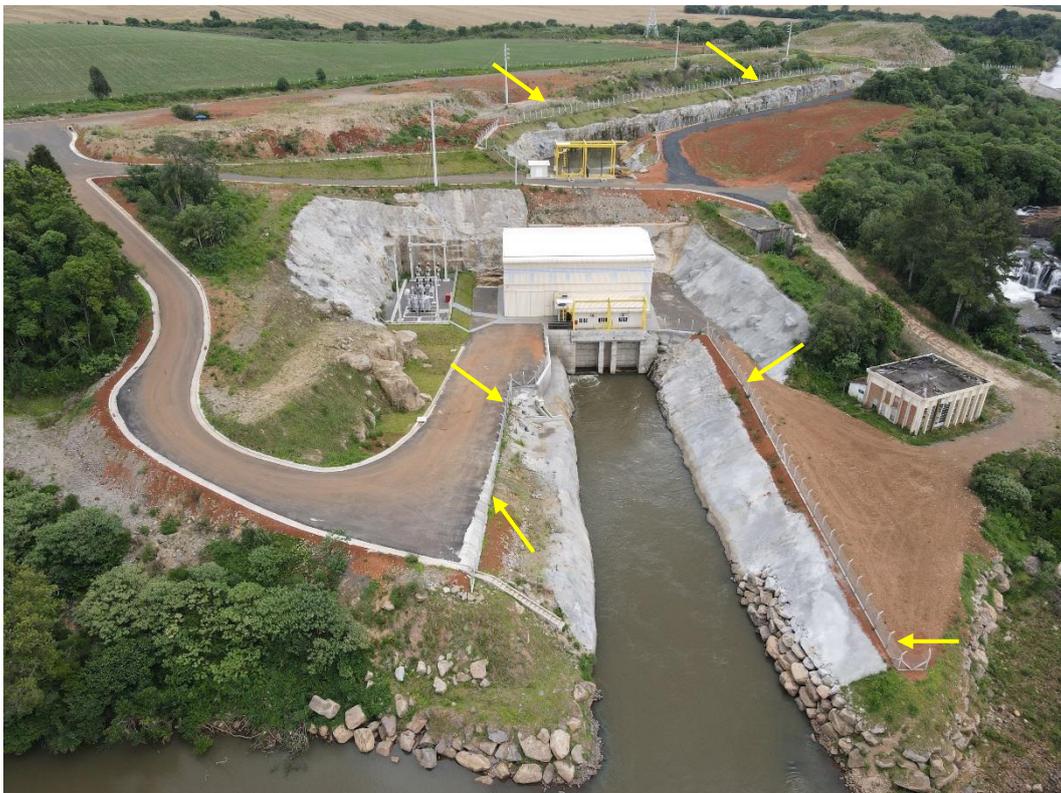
VISTA GERAL DO CERCAMENTO DA CASA DE FORÇA , CANAL DE FUGA E, AO FUNDO CANAL DE ADUÇÃO (JANEIRO/2025)
